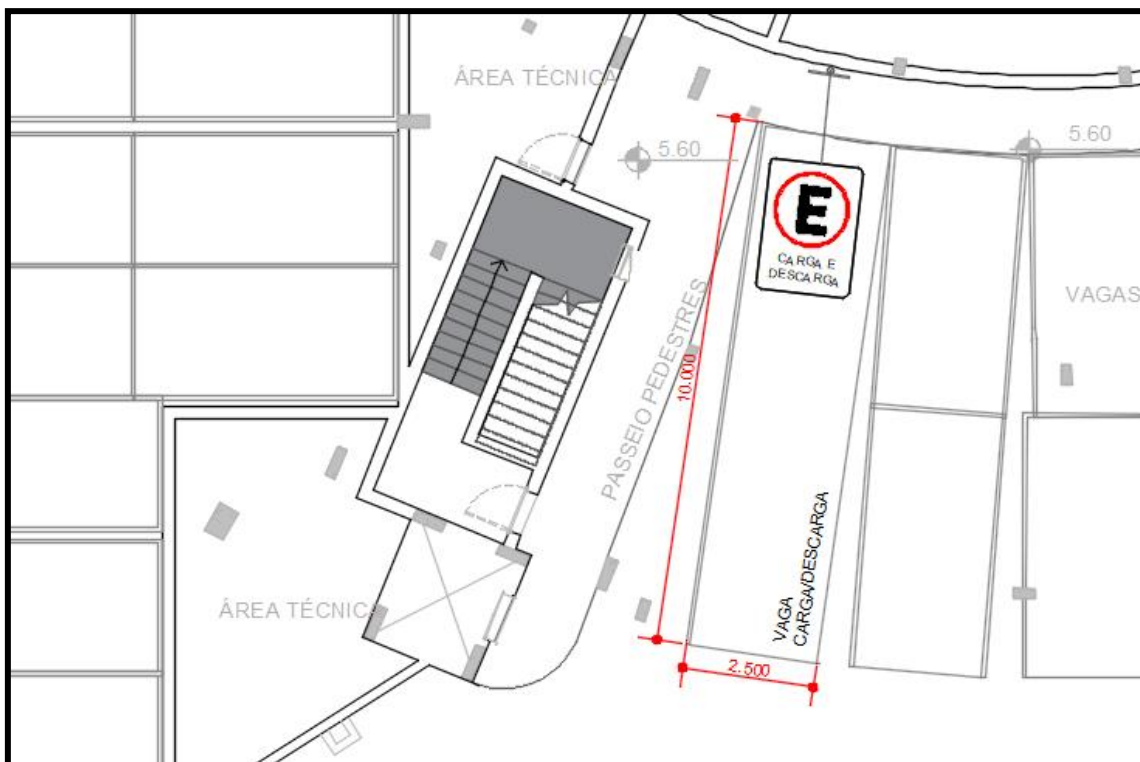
Detalhes da vaga Carga/Descarga - Pavimento subsolo. Fonte: Projeto Arquitetônico, 2025.
